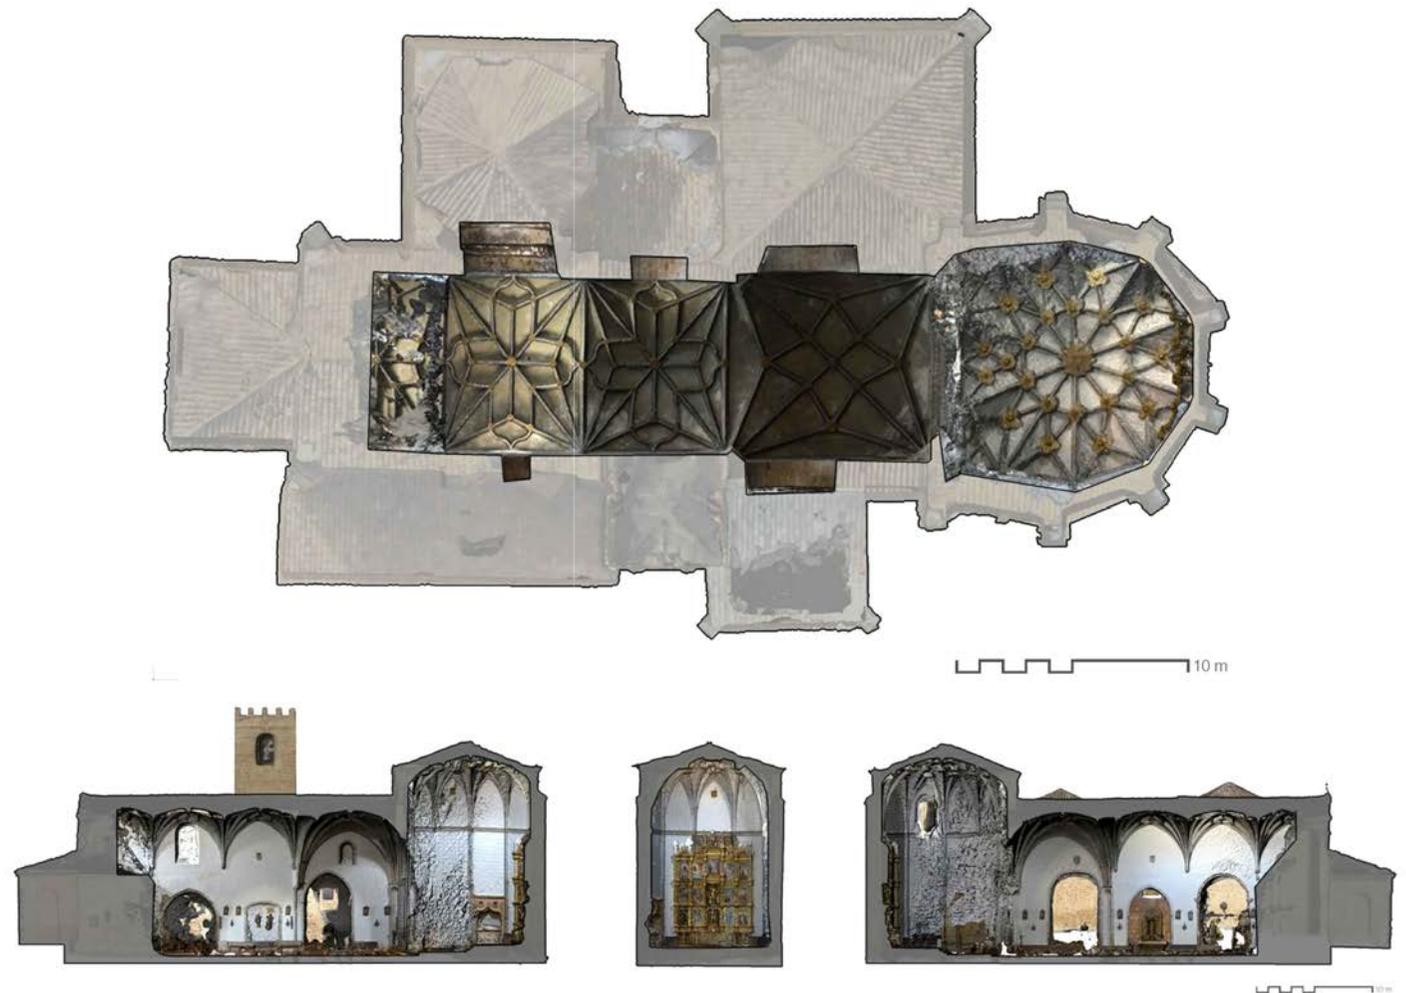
Planta cenital, secciones longitudinales y transversal de la nave principal. Fuente: elaboración propia.
